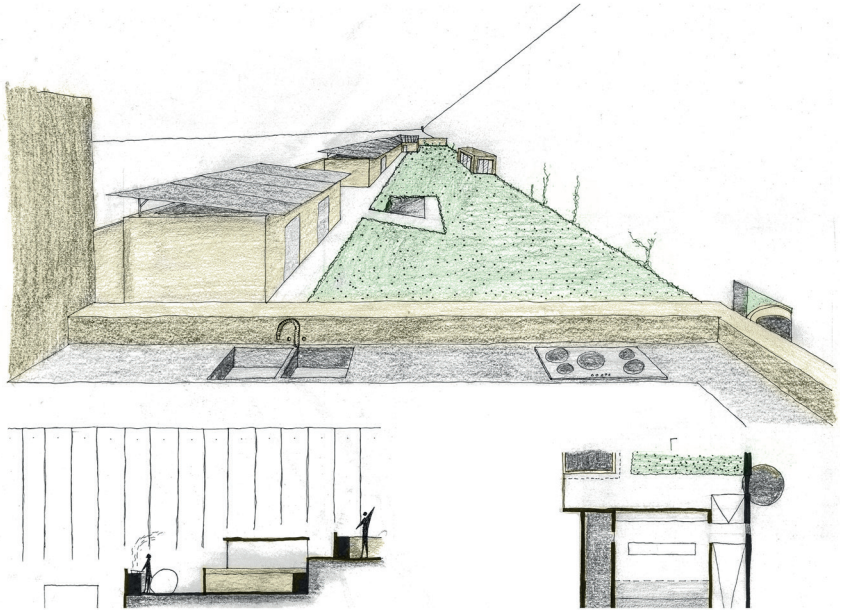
Uitzicht vanaf de terrassen. Met speciale aandacht voor de zichtlijnen.
